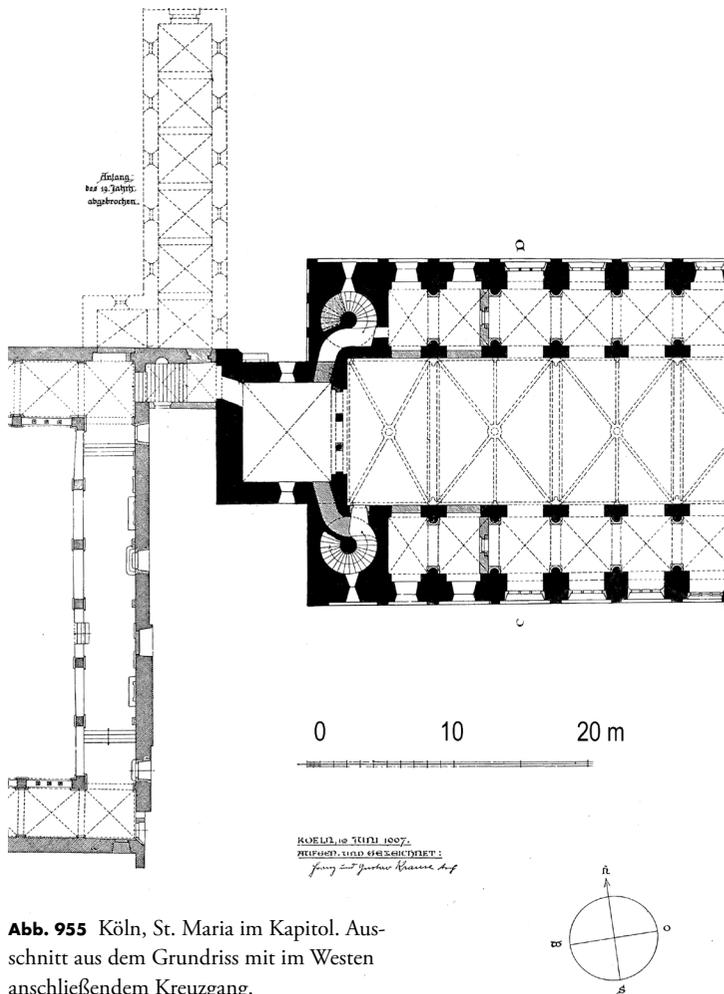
Köln, St. Maria im Kapitol. Ausschnitt aus dem Grundriss mit im Westen anschließendem Kreuzgang.
